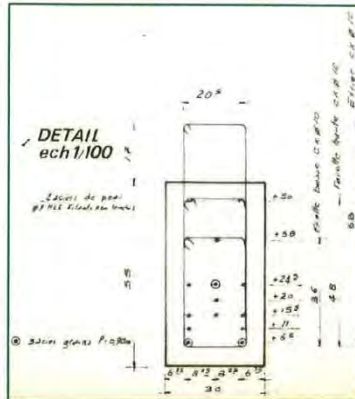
Plan de ferrailage des poutres - Coupe transversale
